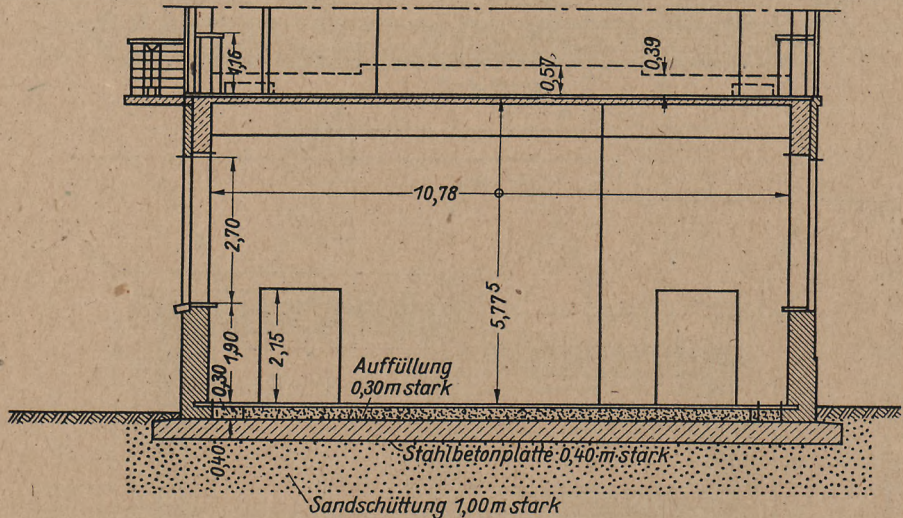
Turnhallegebäude auf Stahlbetongrundplatte
